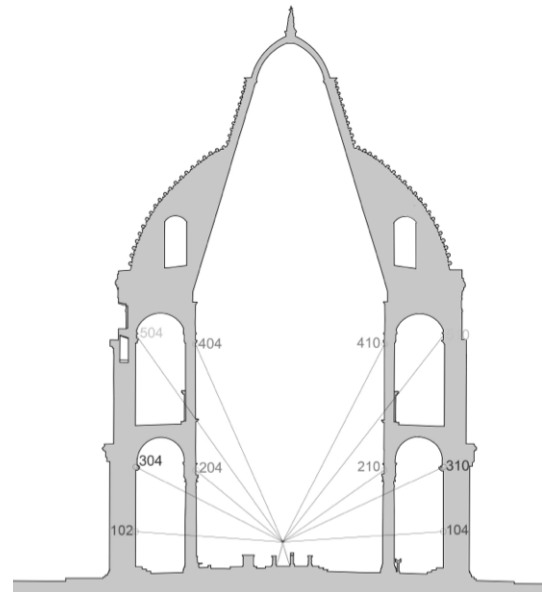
Schema di installazione dei prismi ottici sulla sezione verticale
